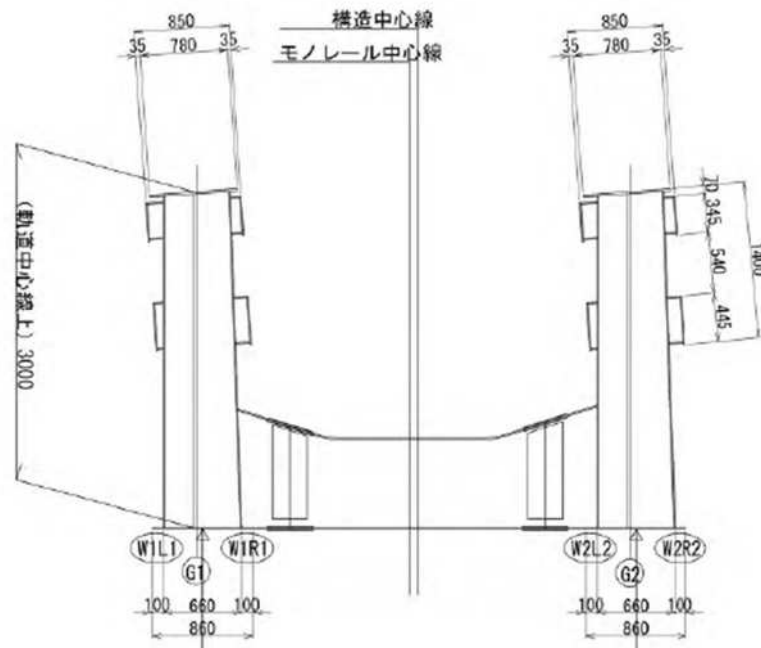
カント 6%を超える鋼軌道桁の断面形状
